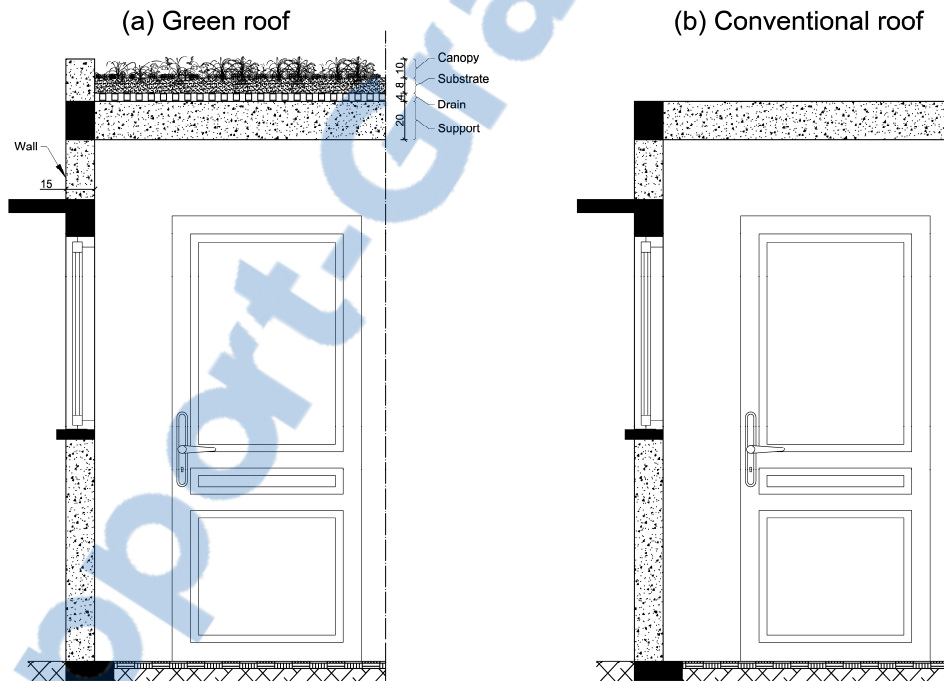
Profils d'un toit vert et d'un toit conventionnel
